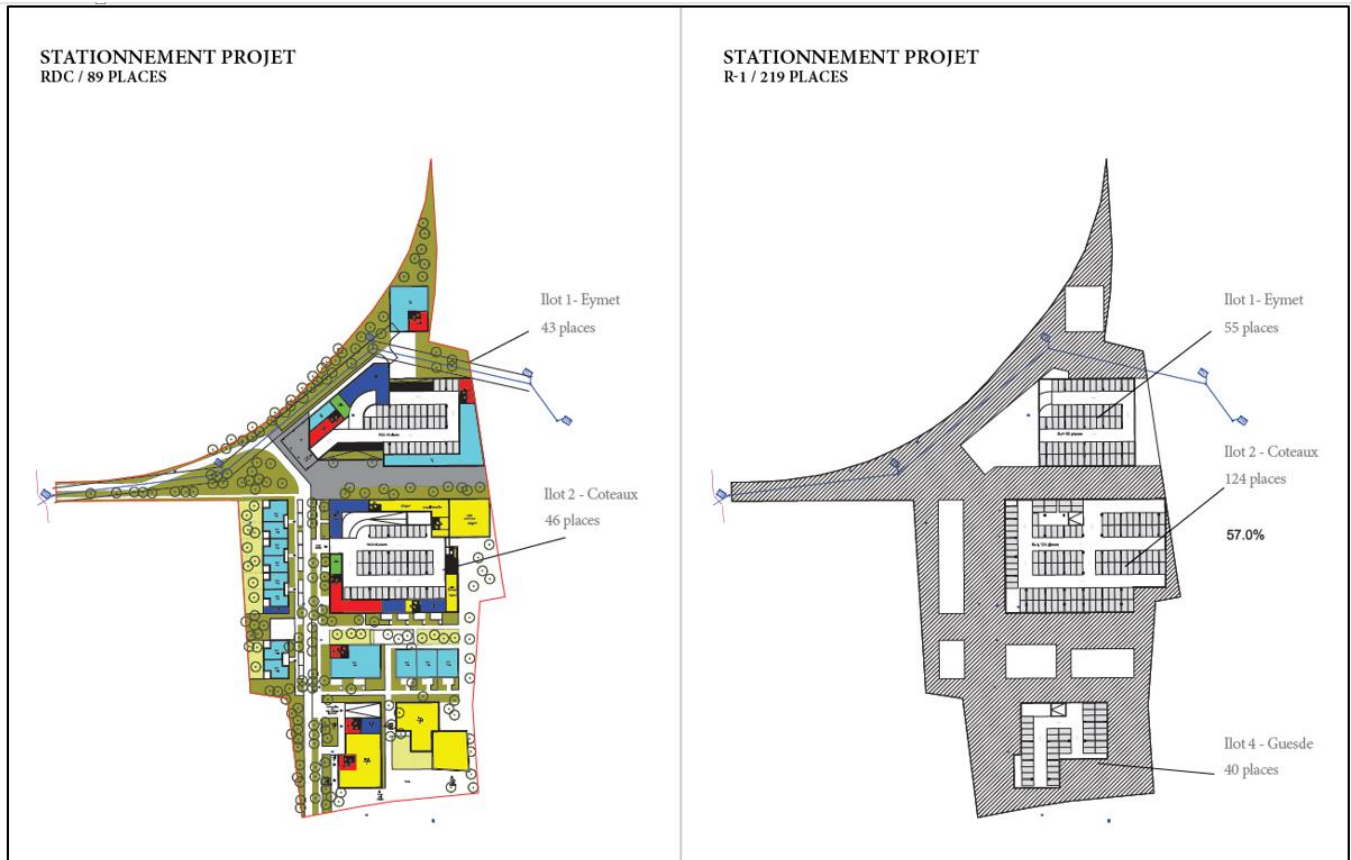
Plans R-1 et RDC des stationnements du projet (Source : ADIM NOUVELLE-AQUITAINE)
